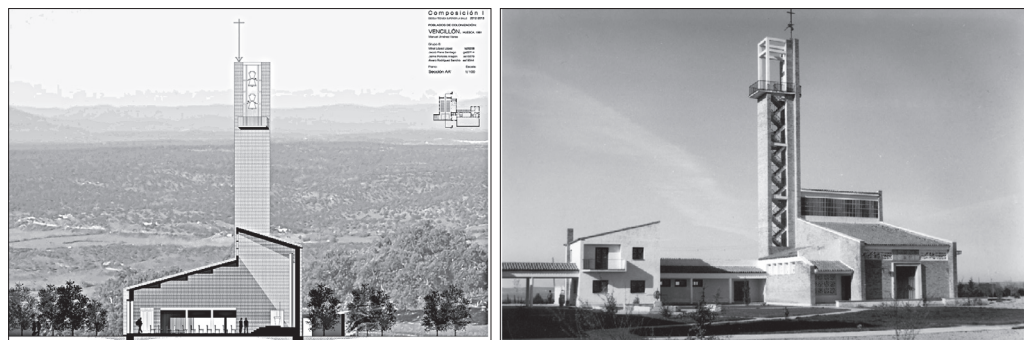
Fotomontaje sobre la sección longitudinal y vista exterior
